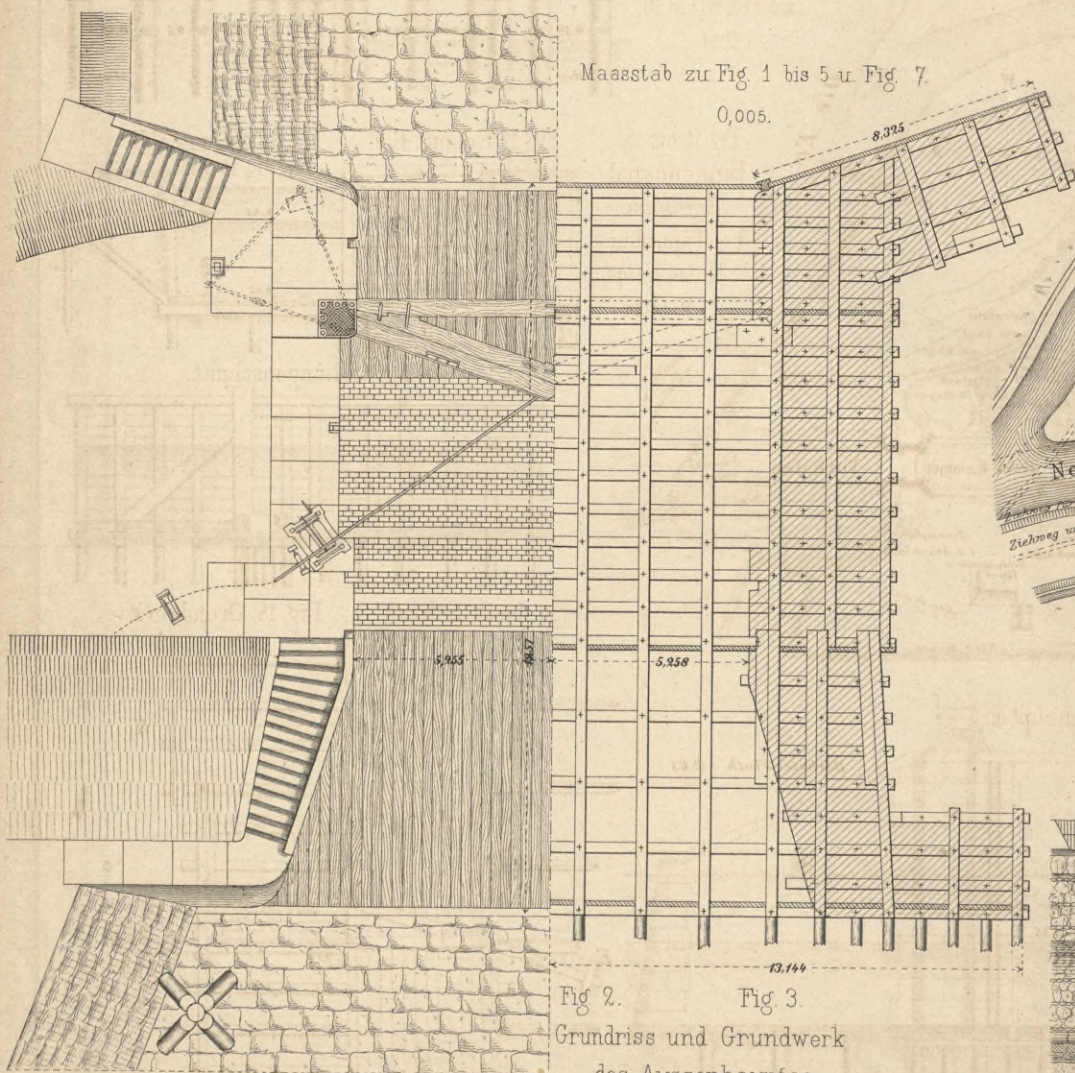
Grundriss und Grundwerk des Aussenhauptes.
